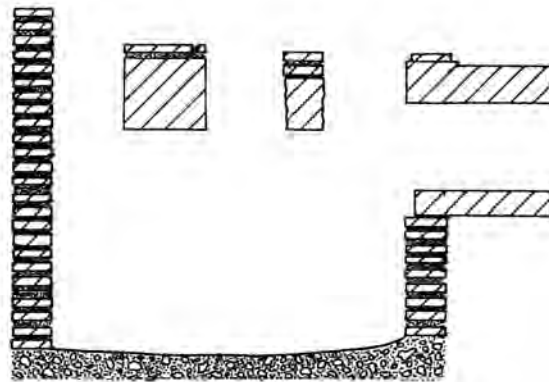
Sección y planta de la estructura excavada en Salinillas de Buradón.
